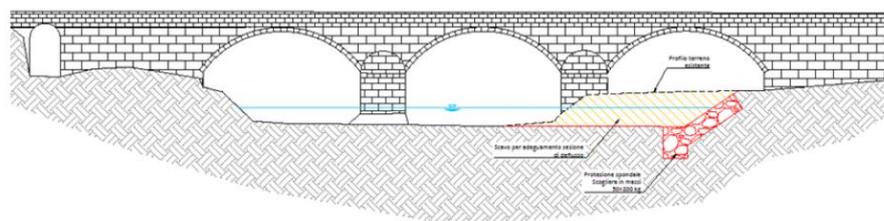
Sezione di progetto intervento ponte AT2200 a Fontecchio.
